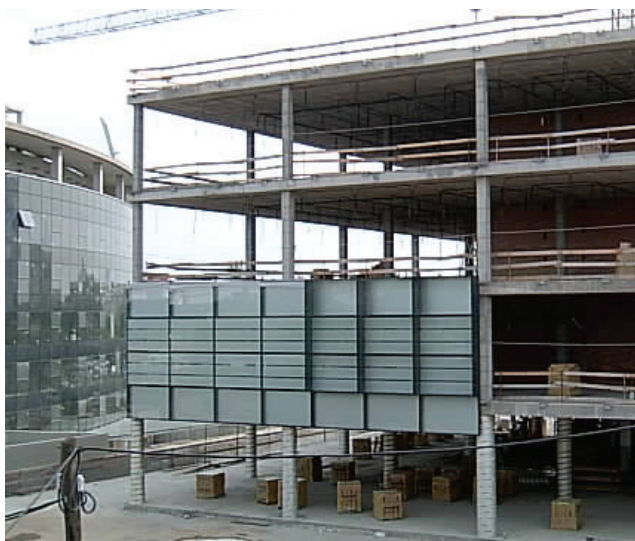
Módulos de fachada con subdivisión de tres perfiles
